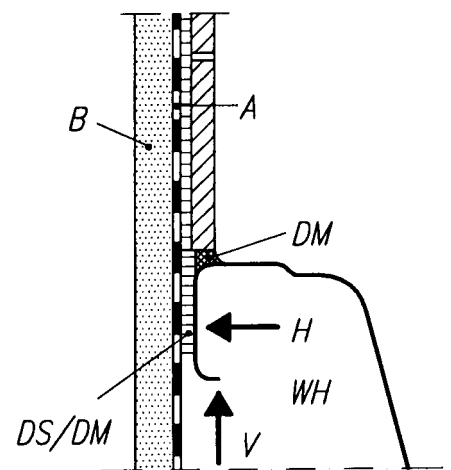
Anschluß wie nach Bild 6.5 mit Wandhal-terung WH, jedoch mit nur einlagiger Be-plankung B der Duschewand; Erläuterungen s. Bild 6.5; Bewertung nach Tabelle 6.2, Zeile 4, zum Teil ein-geschränkt
